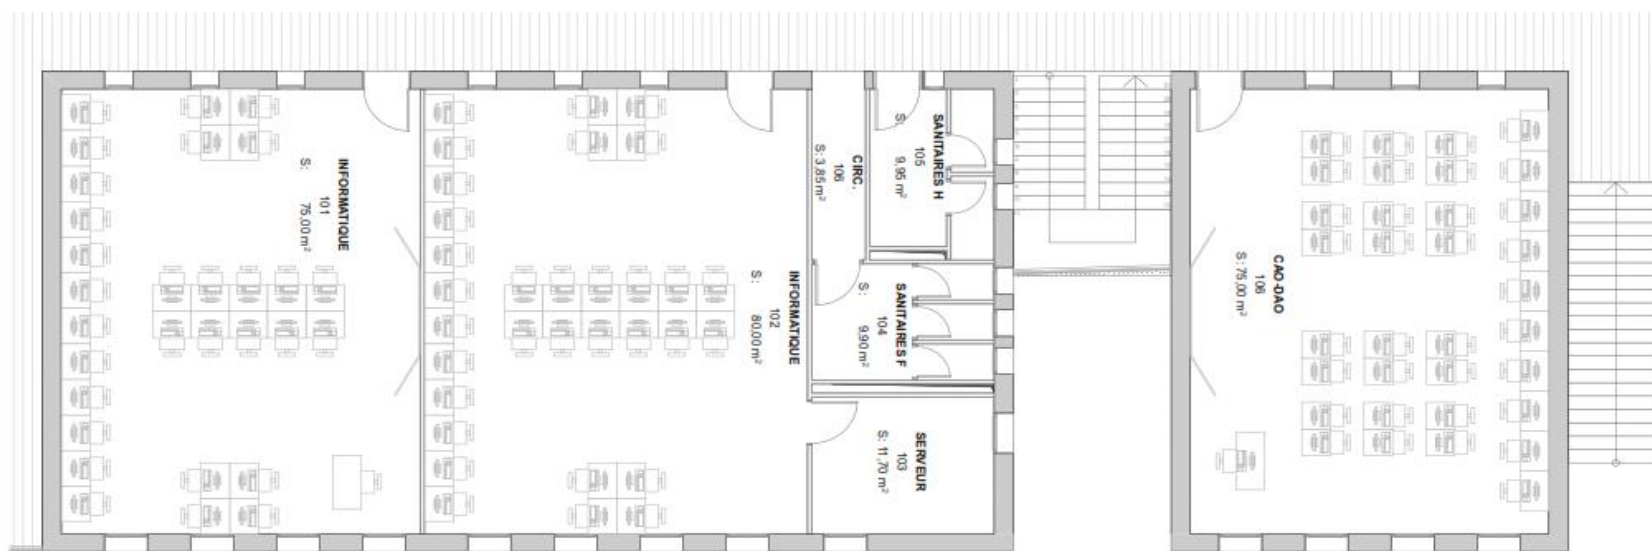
Plan de la salle de classe spécialisée Niveau 1
